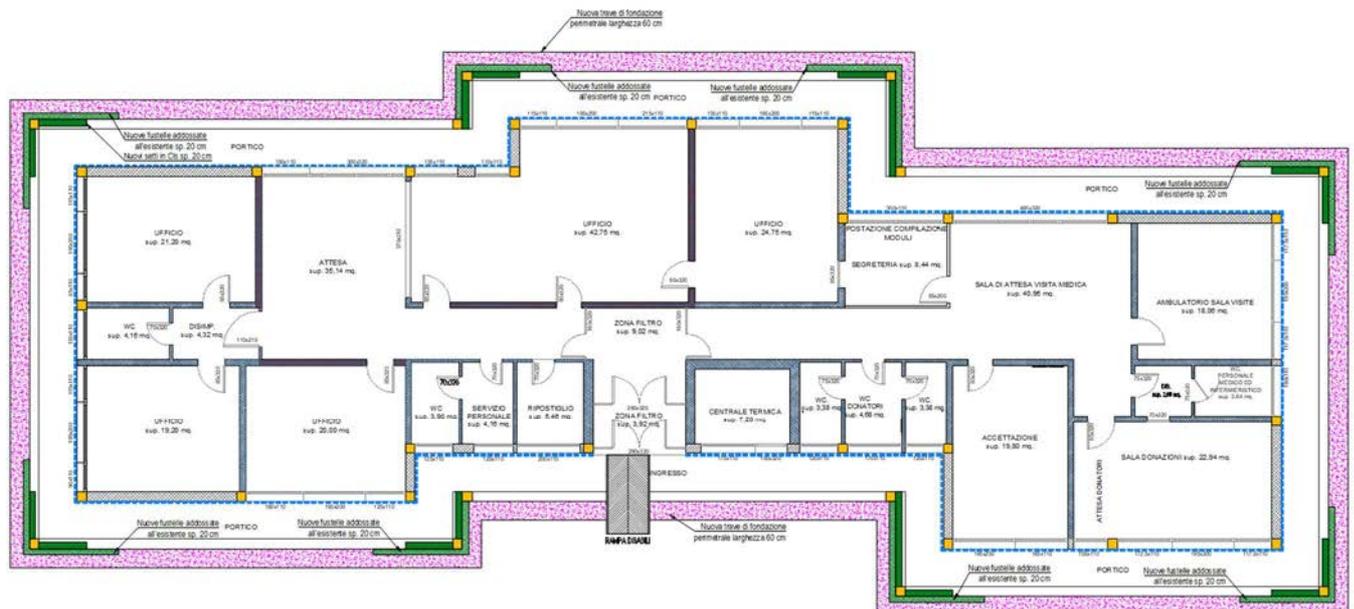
estratto dal progetto originale - dettaglio fondazione perimetrale
